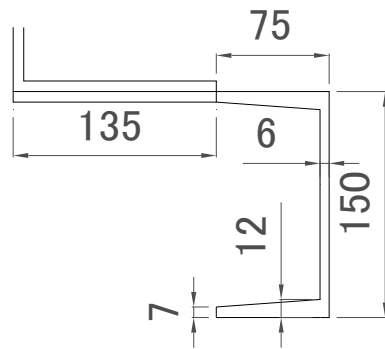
Cチャンネルの断面図 (単位: mm)
